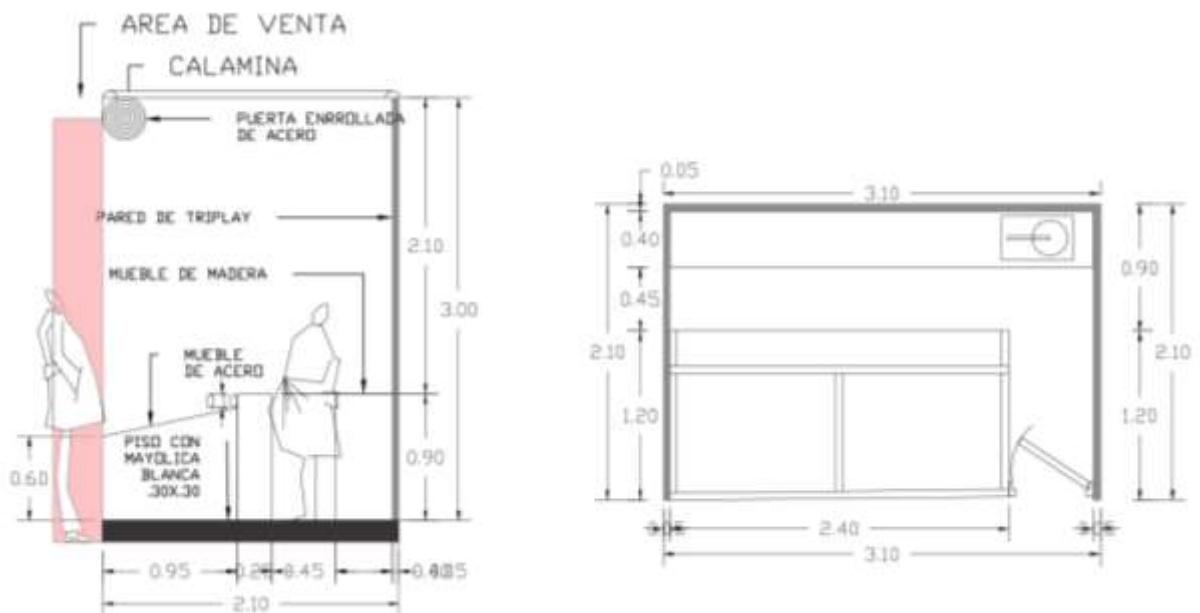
Corte Detallado y planta del Puesto de Carnes / Elaboración propia
